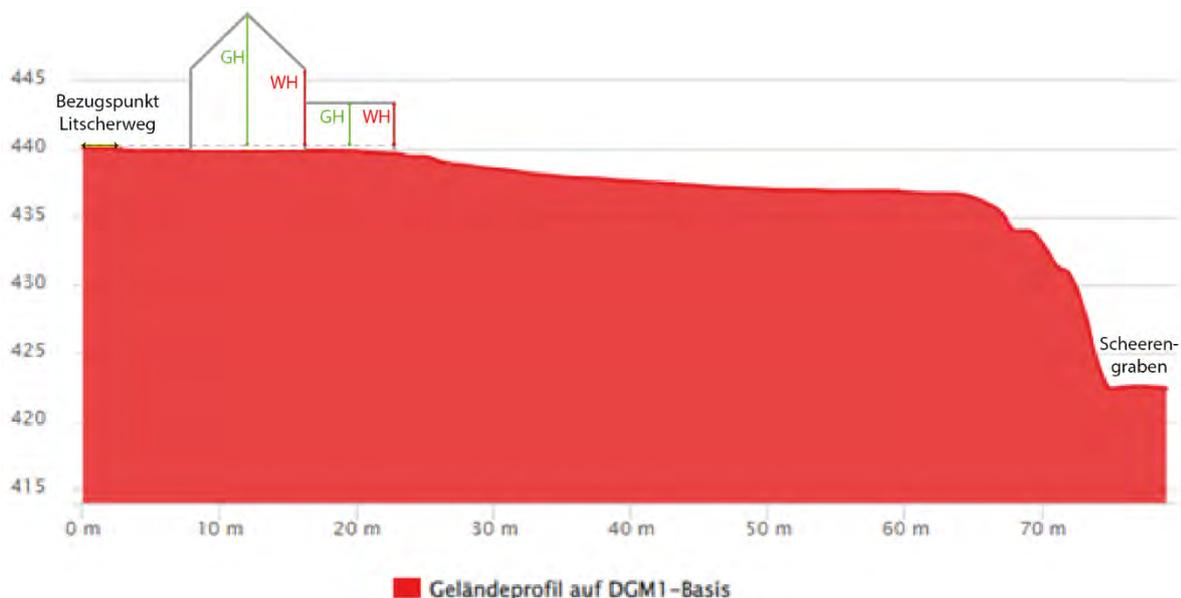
Geländeprofil und Darstellung Bezugspunkt Höhe, Planstatt Senner
